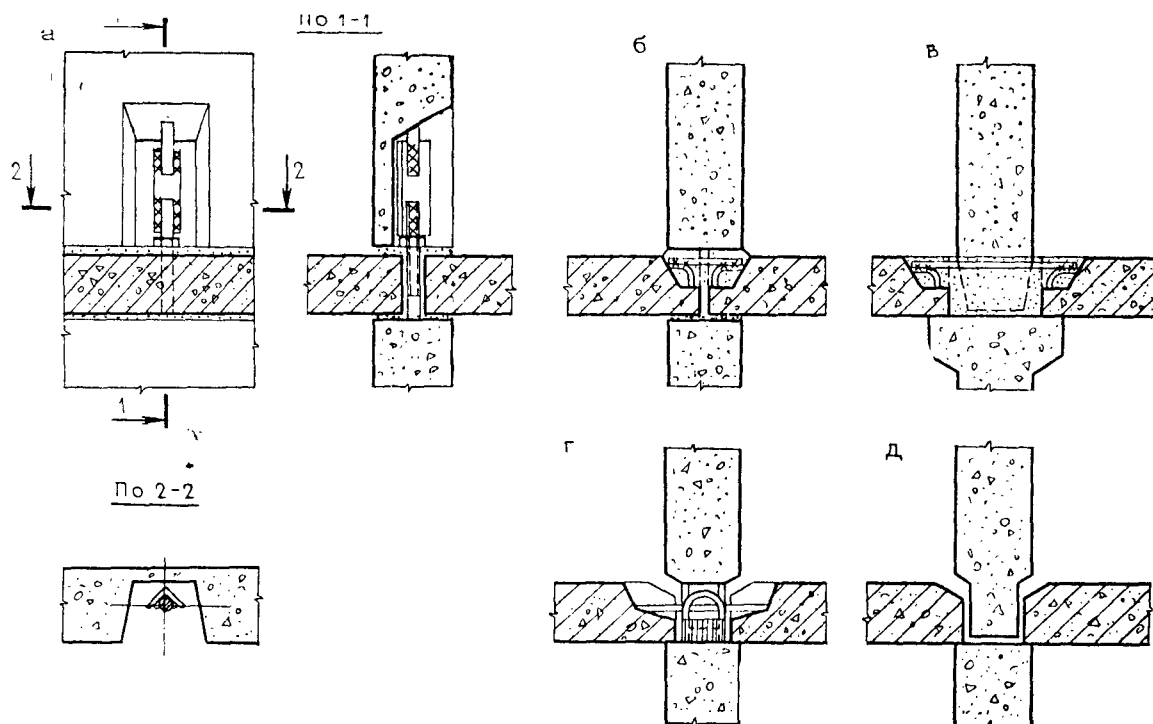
Стальные связи в горизонтальных стыках панелей внутренних стен с перекрытиями
